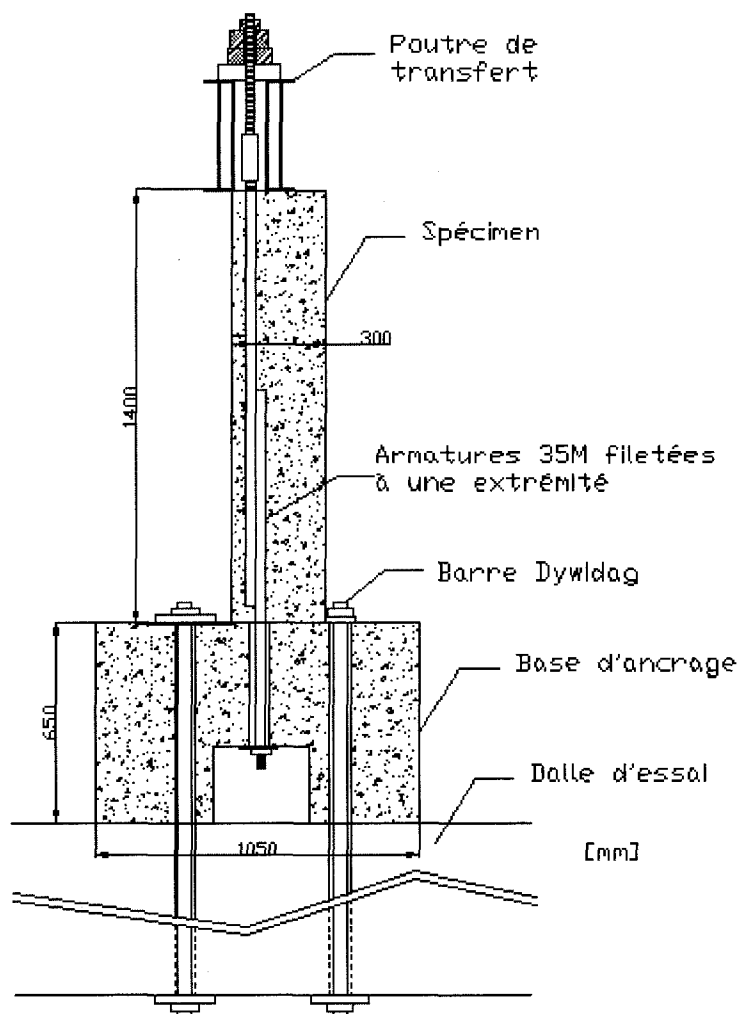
Dessin en coupe du spécimen installé pour l'essai d'arrachement
